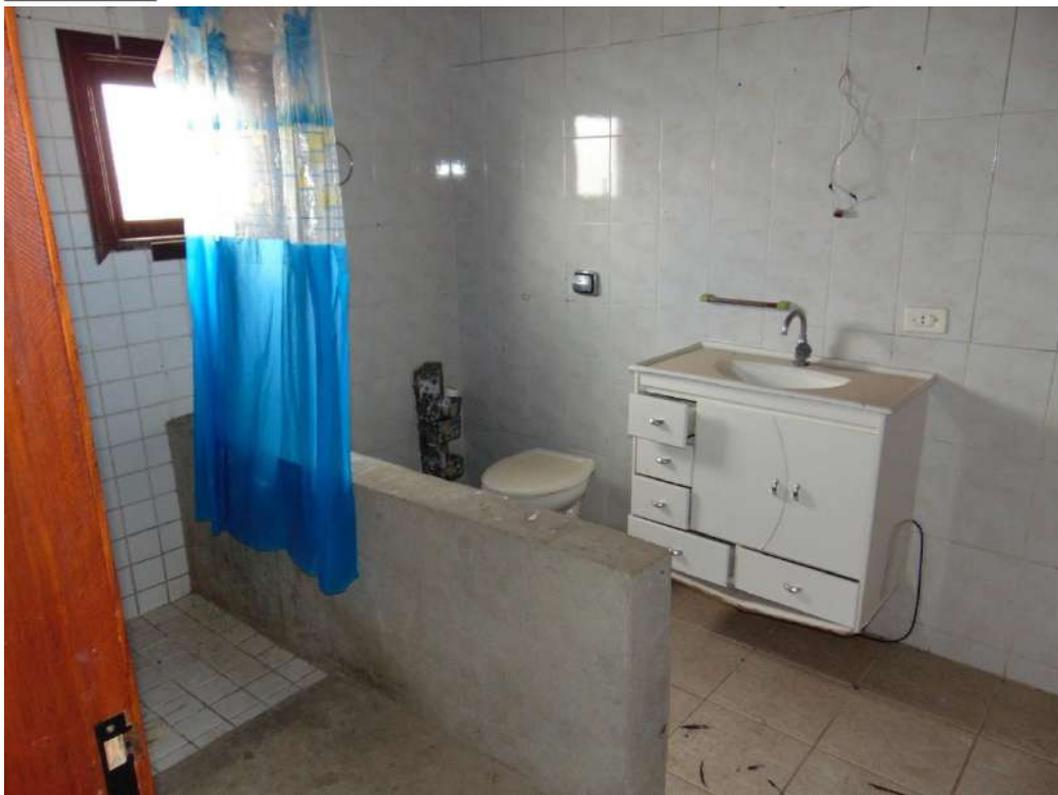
Banheiro da Suíte 2, com mureta inacabada, avarias no gabinete, instalações aparentes
